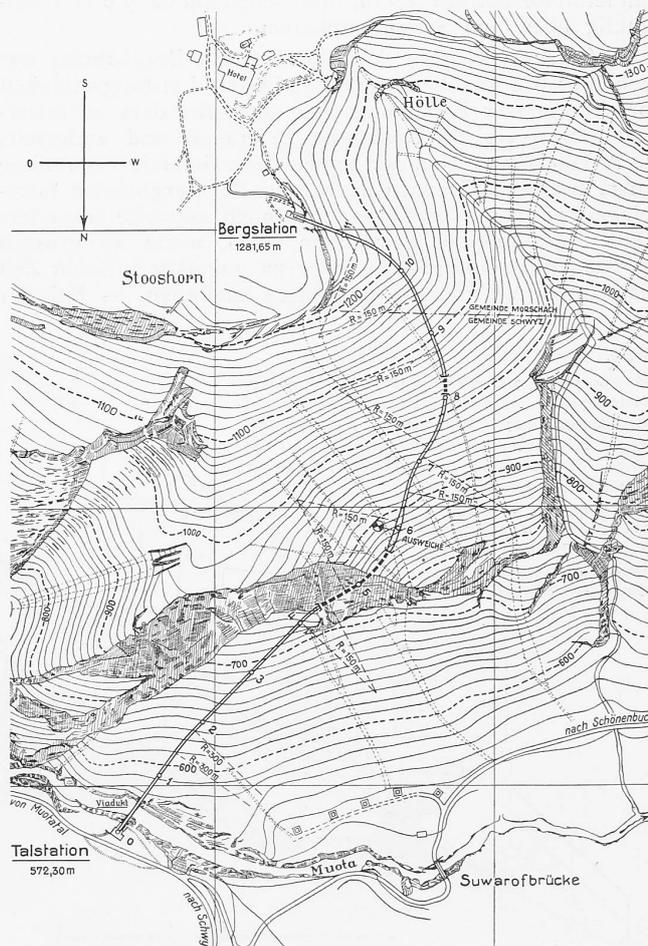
Lageplan der Seilbahn Schwyz-Stoos. — Masstab 1 : 10 000.
